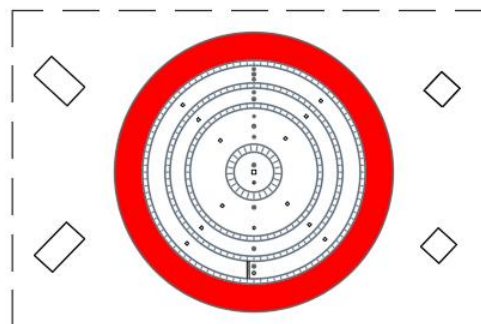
Planta: Área de rojo indica el sector de piso de concreto pulido de e=8cm A DEMOLER alrededor de la pileta.
